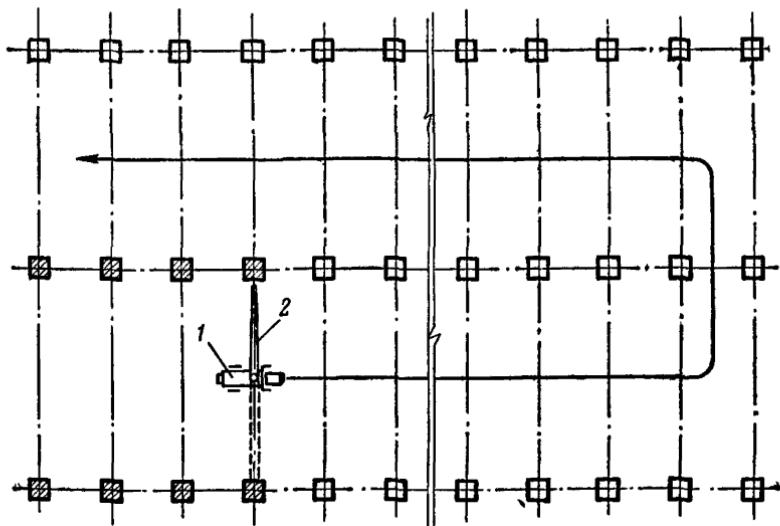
Схема бетонирования отдельно стоящих фундаментов автобетононасосом с распределительной стрелой
